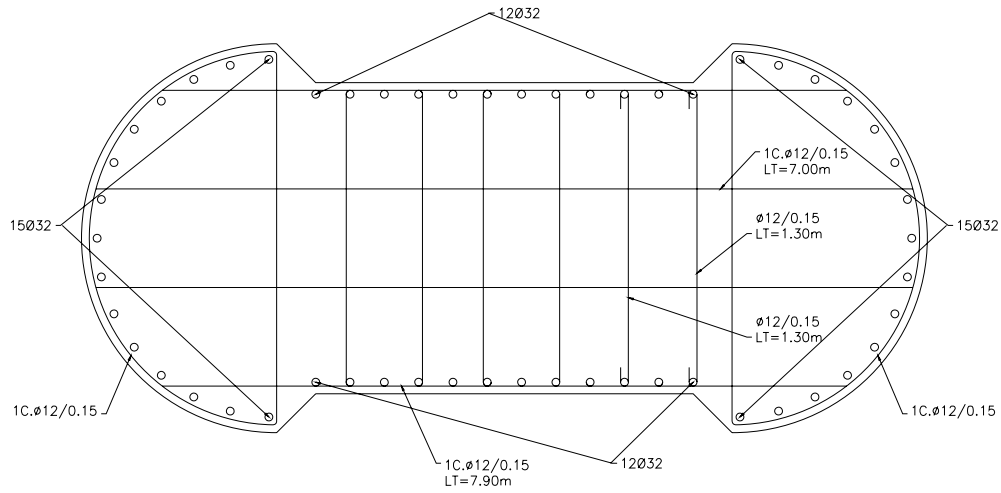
Detalle de armado de las pilas. Sección básica
